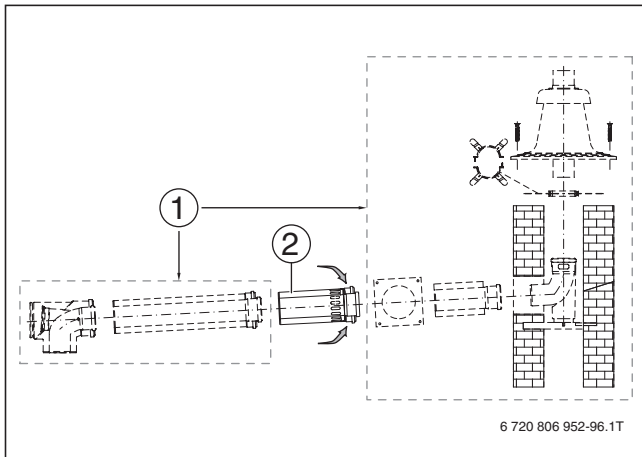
Bauteile Grundbausatz GA-X in Verbindung mit Grundbausatz GA-K
